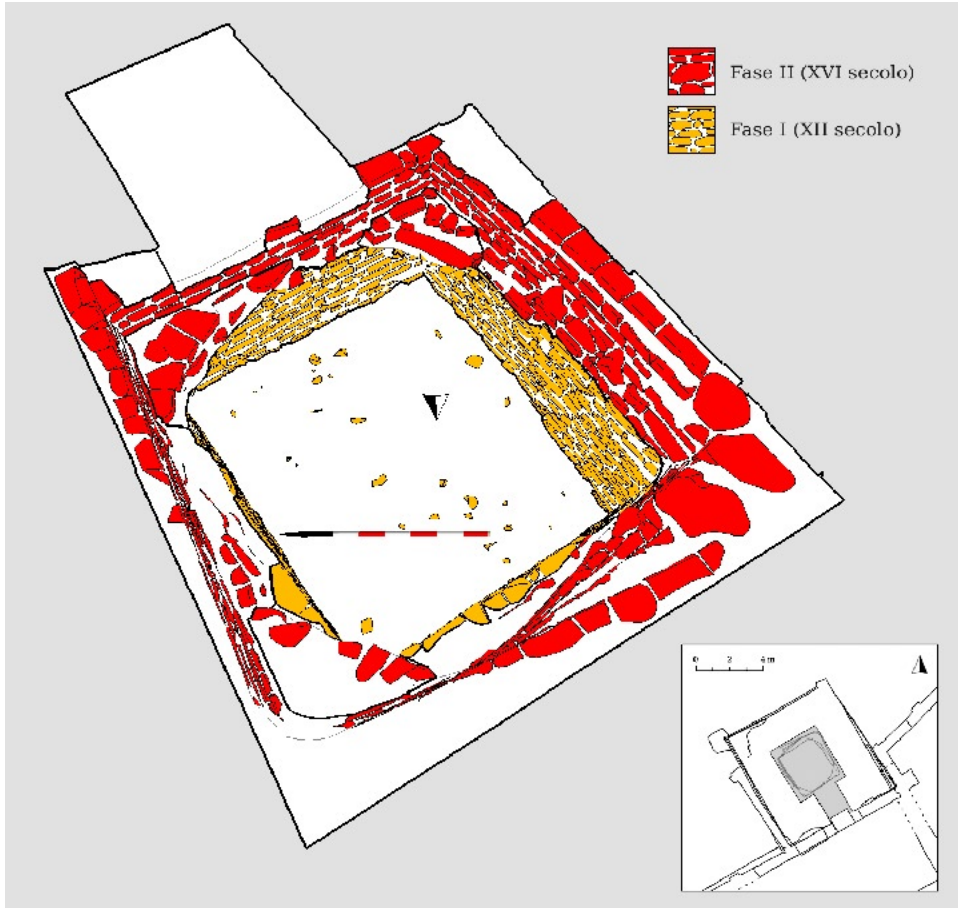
Campanile di San Severo (Ravenna, RA). Restituzione tridimensionale degli elementi strutturali e della stratigrafia muraria, con individuazione delle diverse fasi edilizie (vista prospettica).
